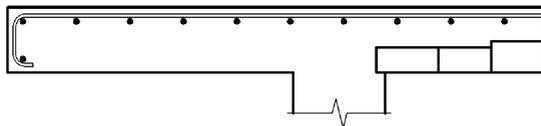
Конструктивное решение монолитного консольного вылета перекрытия
